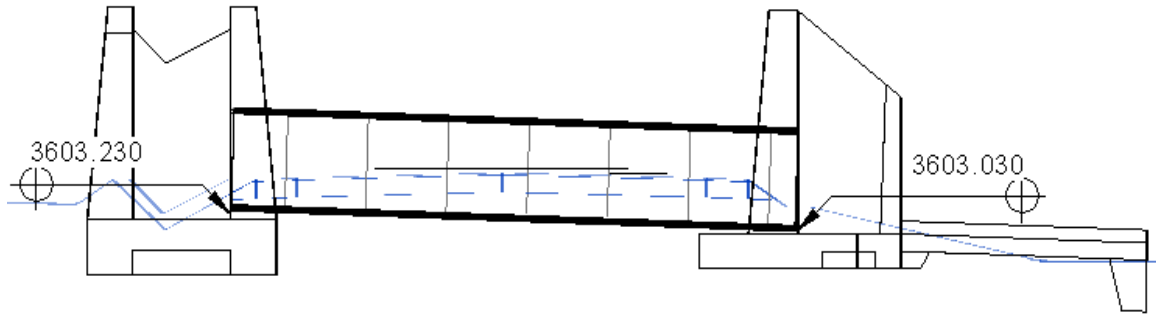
Ubicación de la alcantarilla proyectada 18+351 en Revit.
